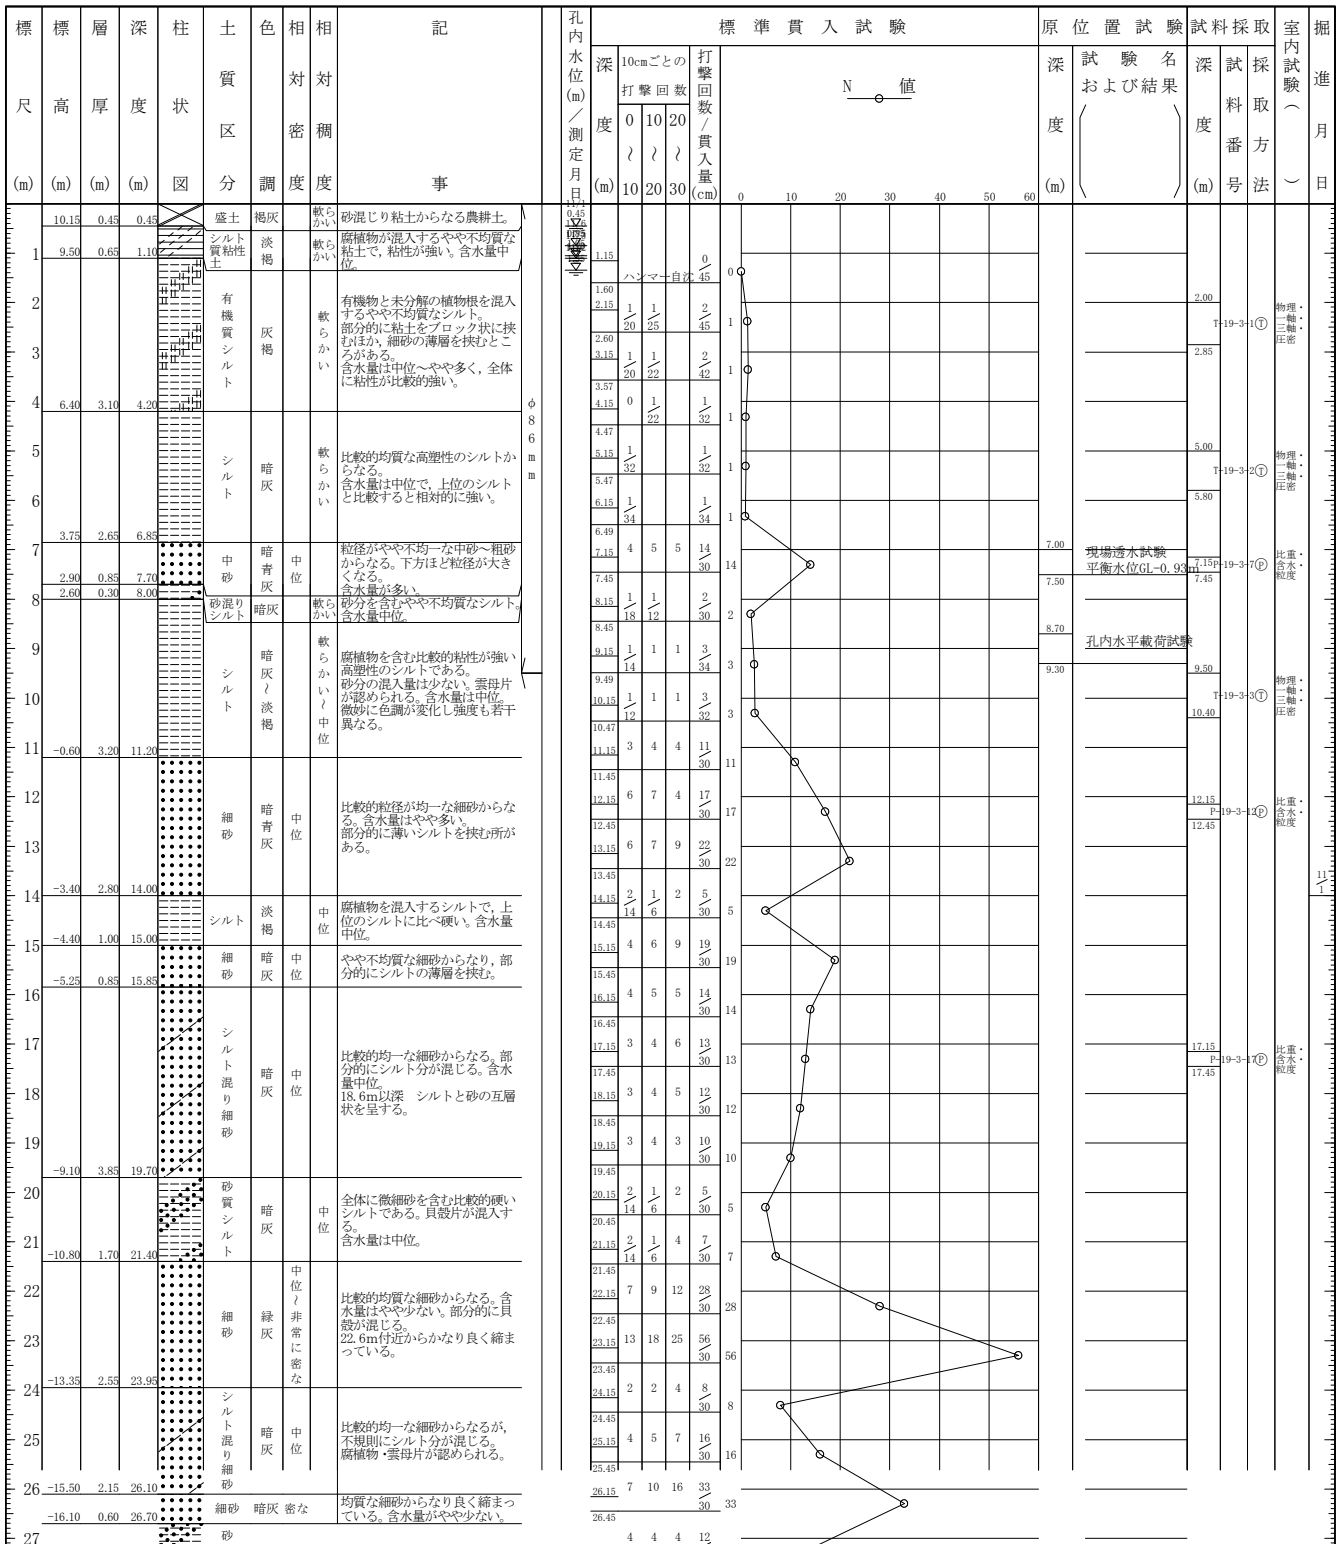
(2) ボーリング柱状図 (No.3-2)
